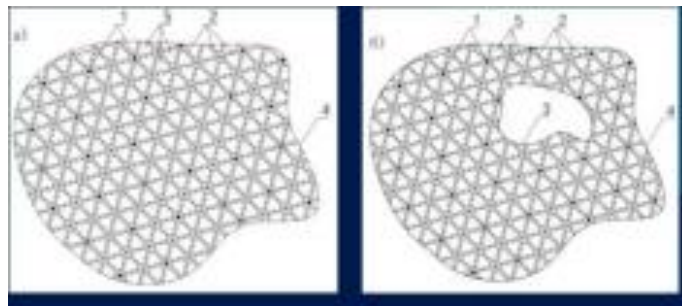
Конструкція фундаментної плити і плити перекриття:
